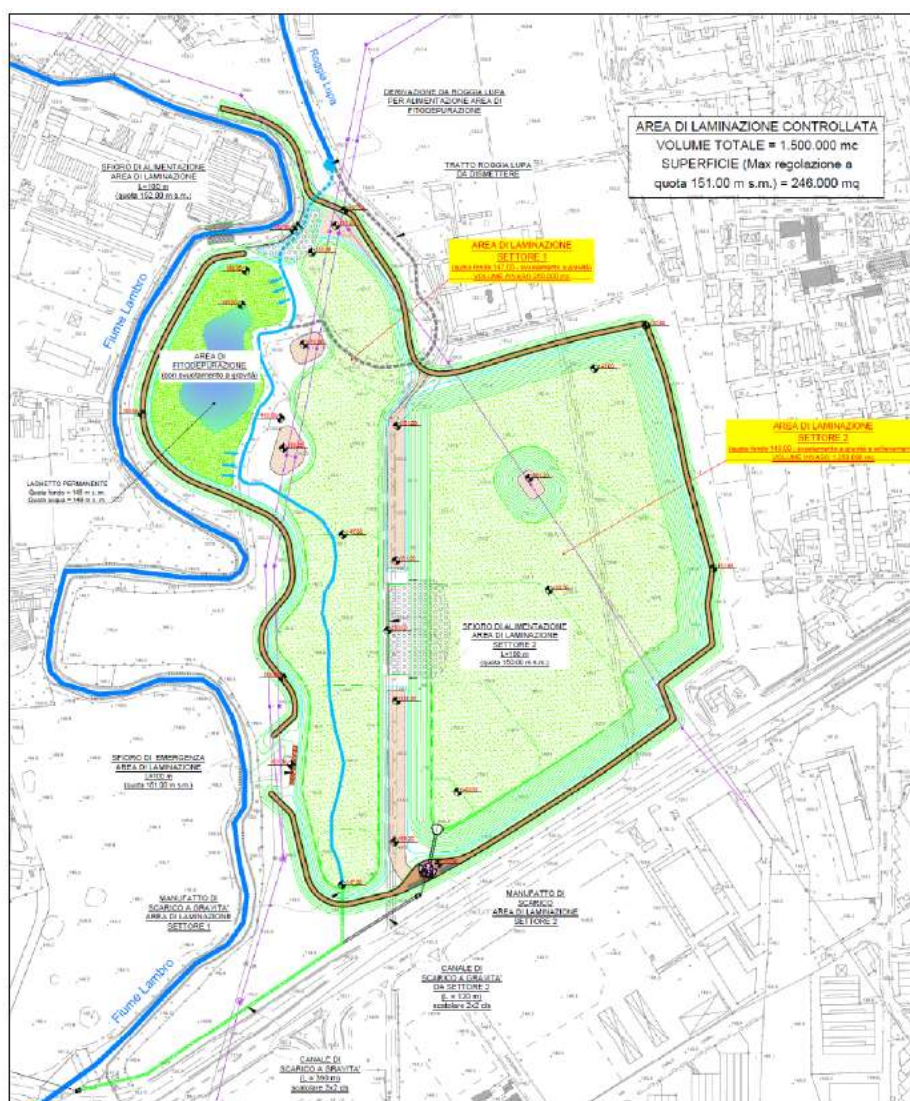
Planimetria dell'area di laminazione in Monza, loc. Cascinazza.
